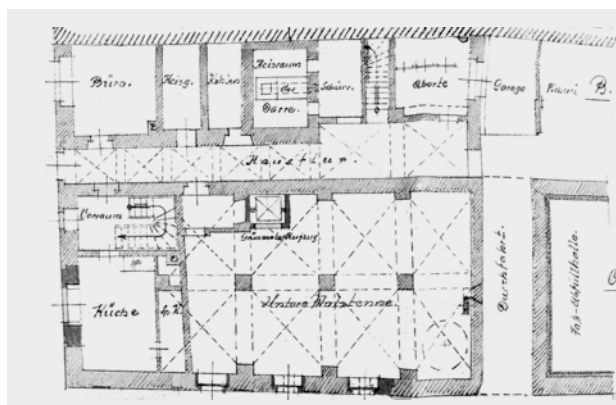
Grundriss Erdgeschoss 1936
